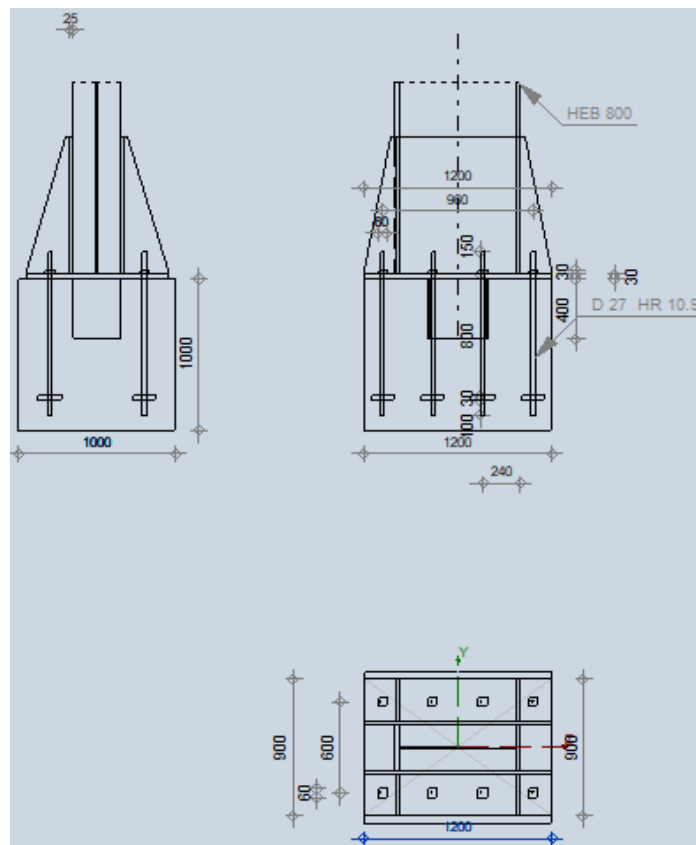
disposition des boulons de l'Assemblage pied de poteau HEB800
